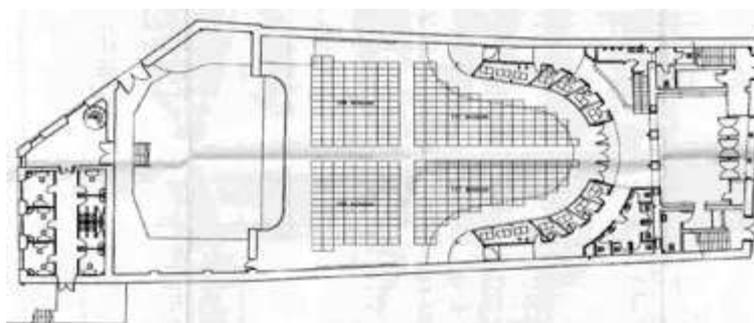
Planta baja reformada [LÓPEZ BERNAL, V., Proyecto de Rehabilitación del Cine Teatro Carolina Coronado de Almendralejo, 2001]
